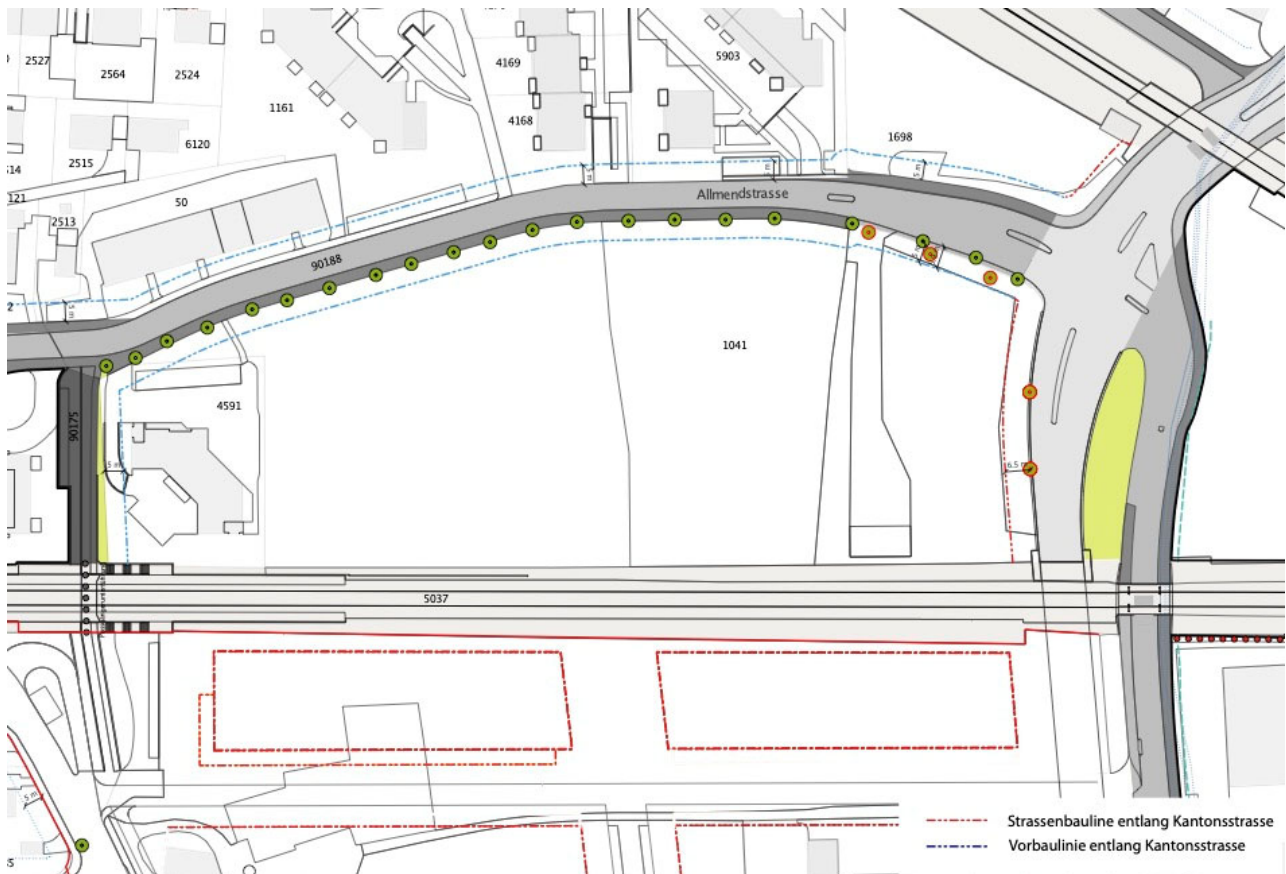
Ausschnitt Erschliessungs- und Baulinienplan, Stand 22.02.2022
